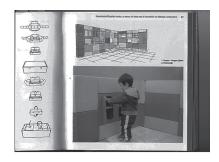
Proyecto Muro/Caja Fuente: Libro Incuba "Un banco de ideas para la innovación en sistemas constructivos" – L. Pablo Barros-Felipe Imhoff – Gustavo Sarabia
